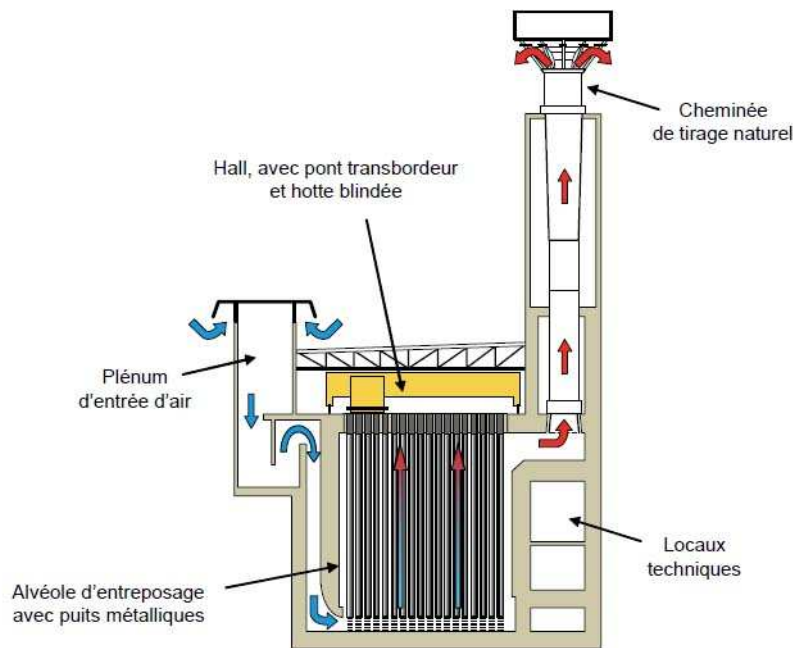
Vue en coupe du nouveau bâtiment et du principe de refroidissement
